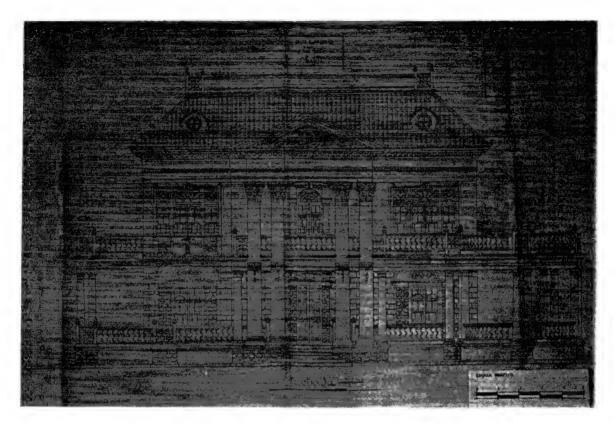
Projeto para a construção de casa à Ladeira da Barra, em 1923, de Júlio Brandão. Fachada Principal.
